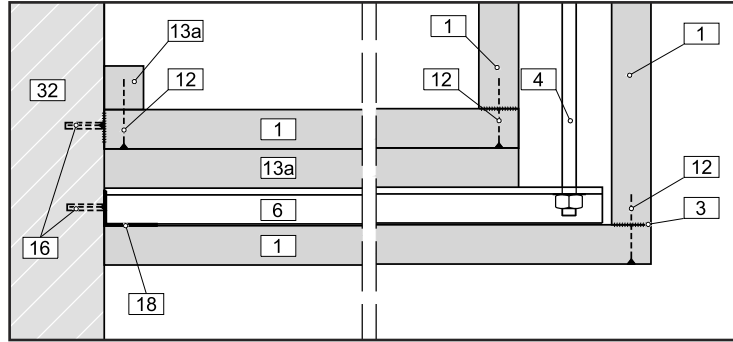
6] Lüftungsleitung ≤ 600 x 600 mm
